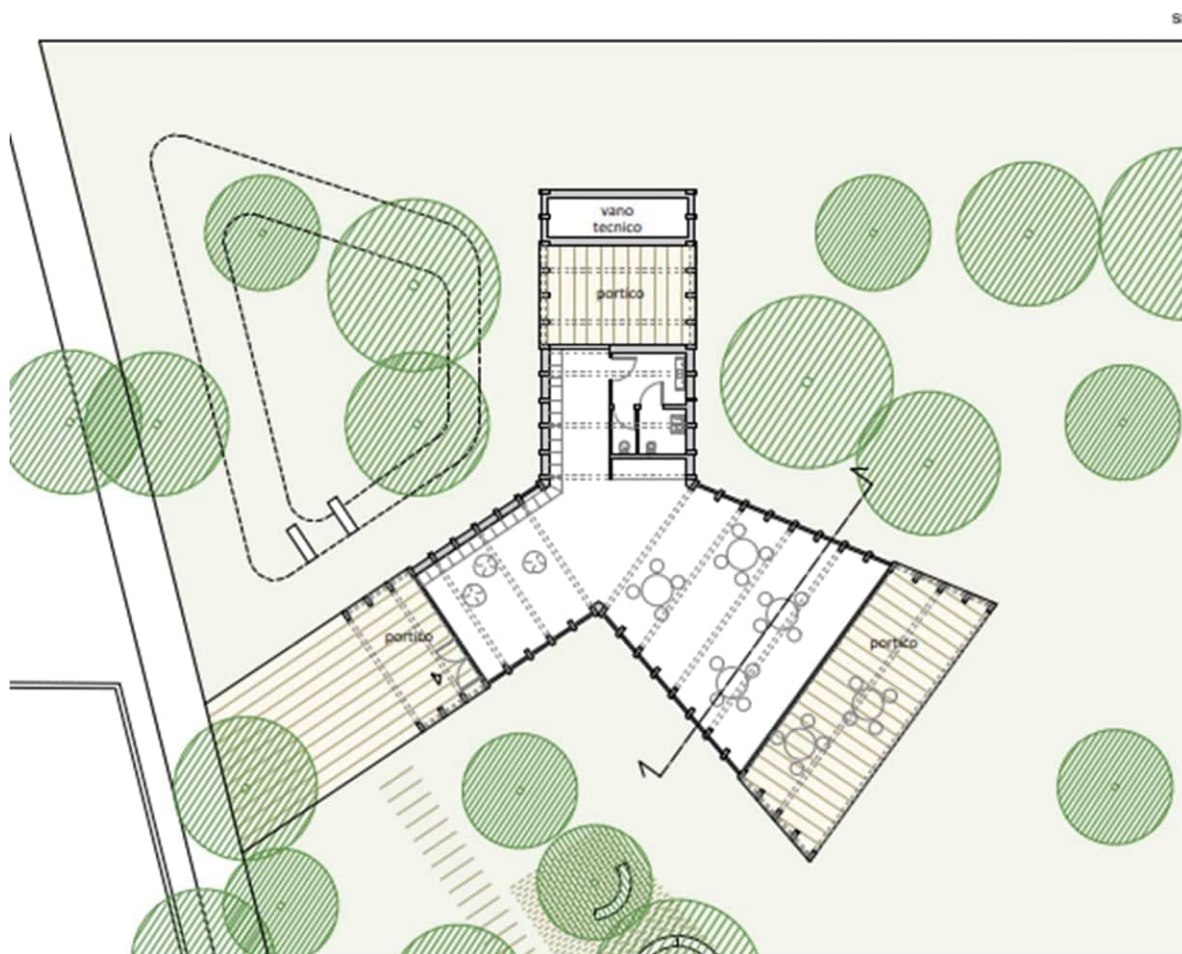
PLANIMETRIA DELL'INTERVENTO
